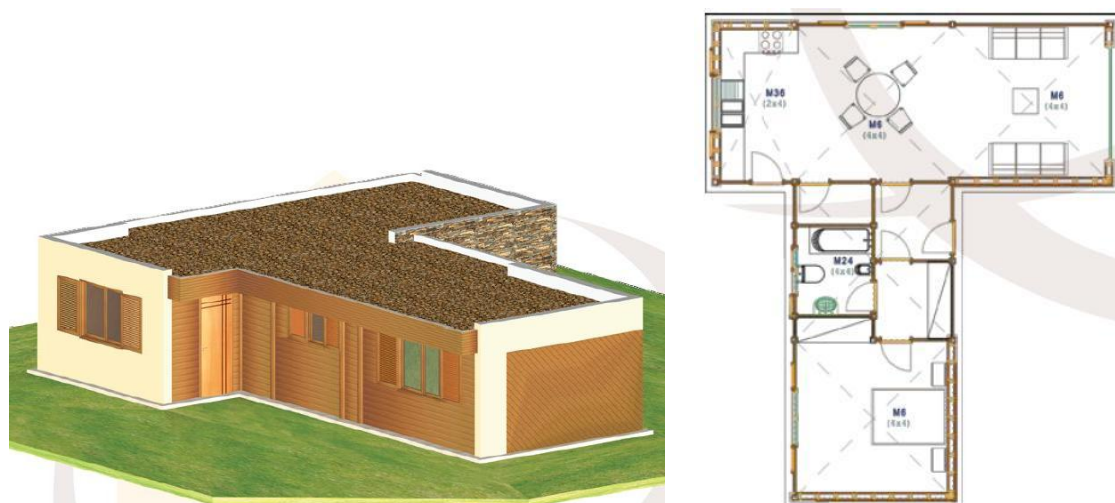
Perspectiva 3D e planta do modelo T1 das casas modulares Imowood [41]
